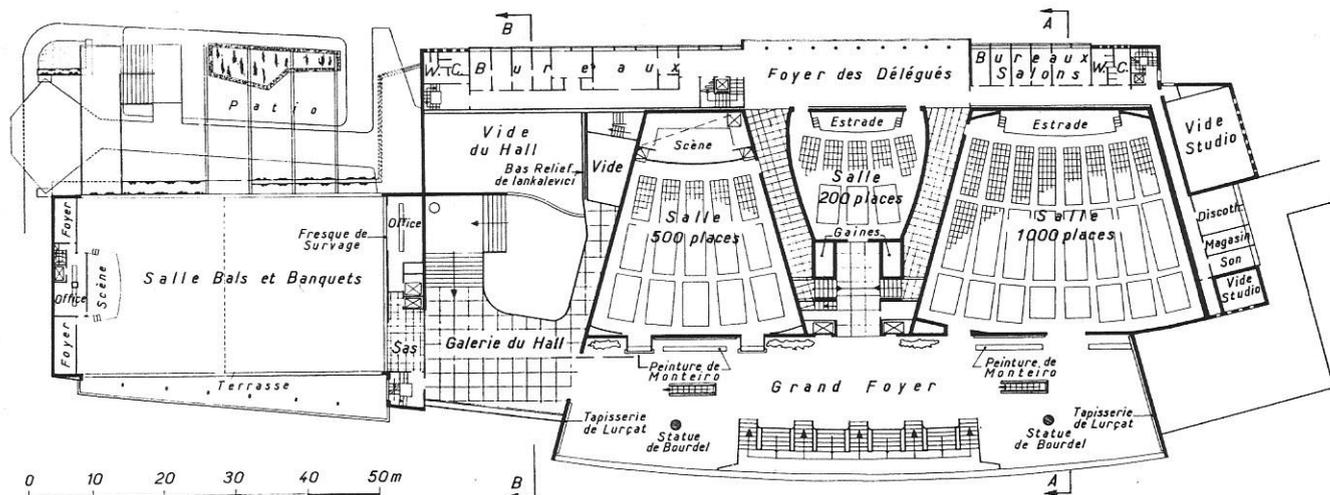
PLAN DU PREMIER ÉTAGE.
